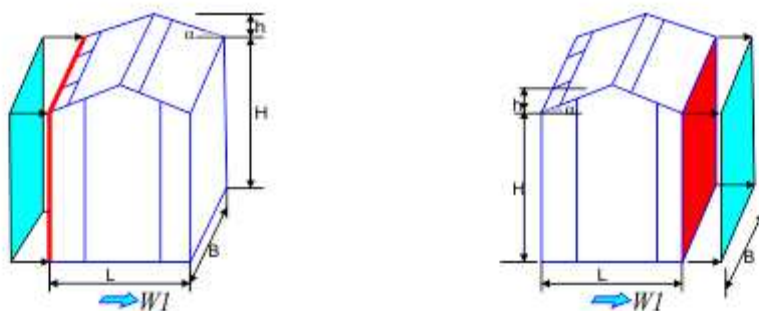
Схема приложения ветровой нагрузки на боковые стены
